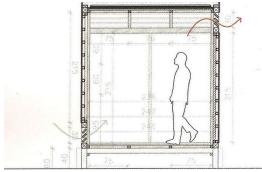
CORTE TRANSVERSAL (MÓDULO 10X10). FONTE: S-AR (2006)
